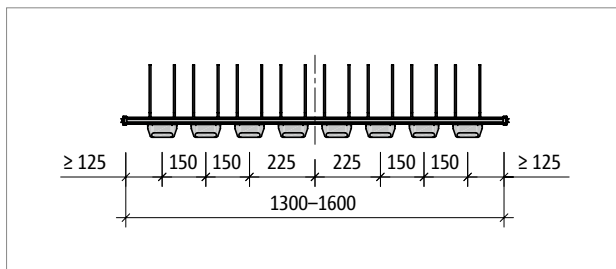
Schöck Tronsole® Typ T-V8-...-L1300 bis L1600: Produktgrundriss
